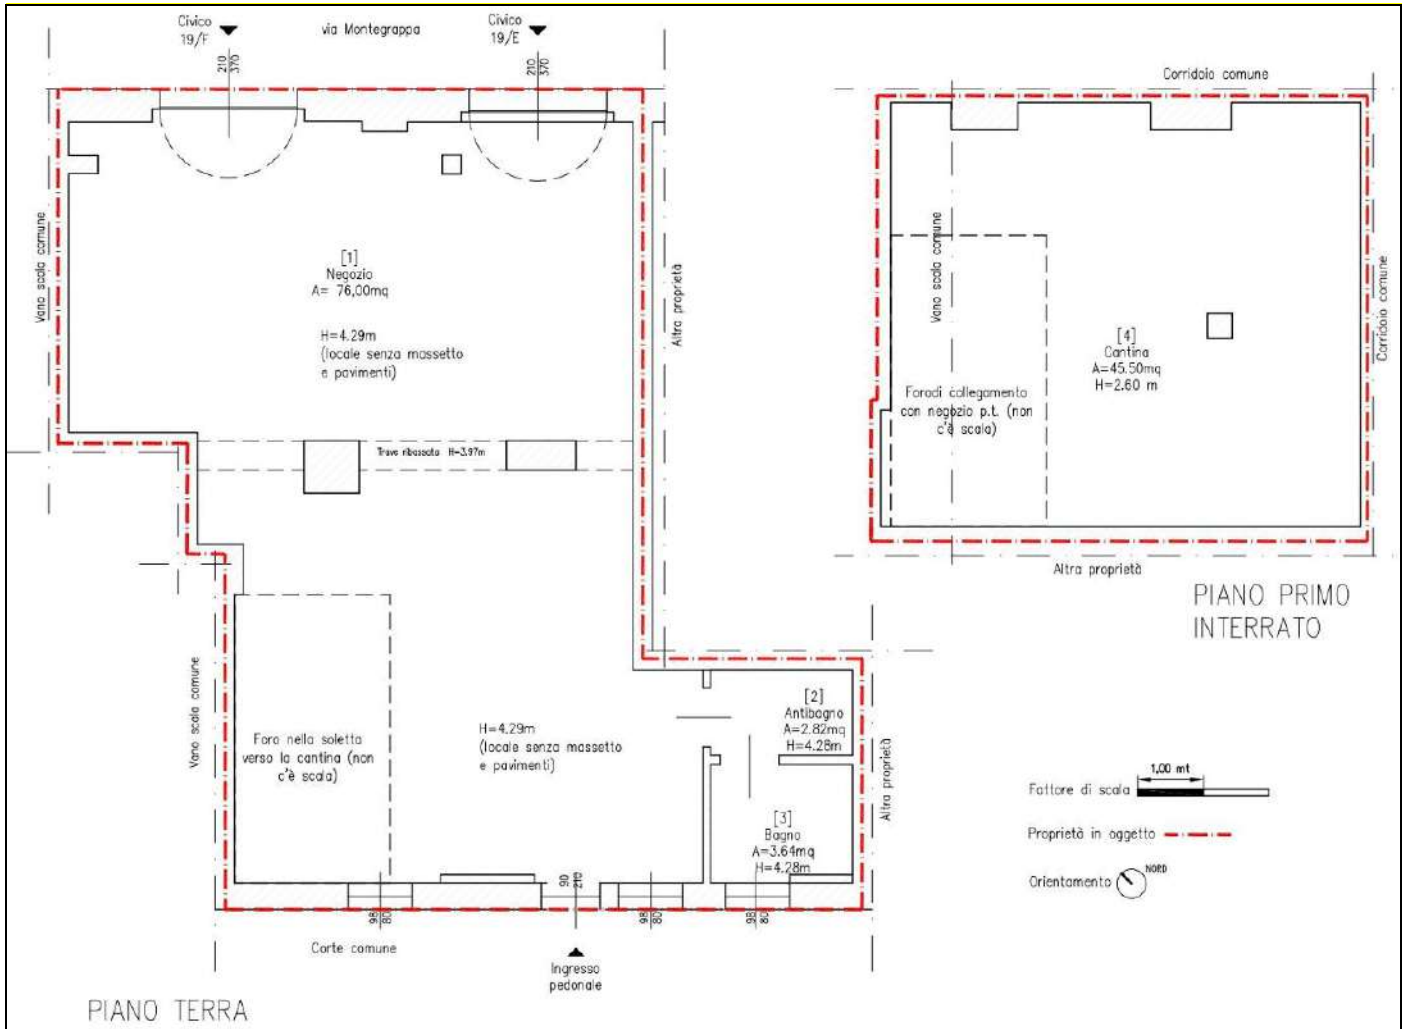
Pianta di rilievo negozio e cantina di pertinenza
